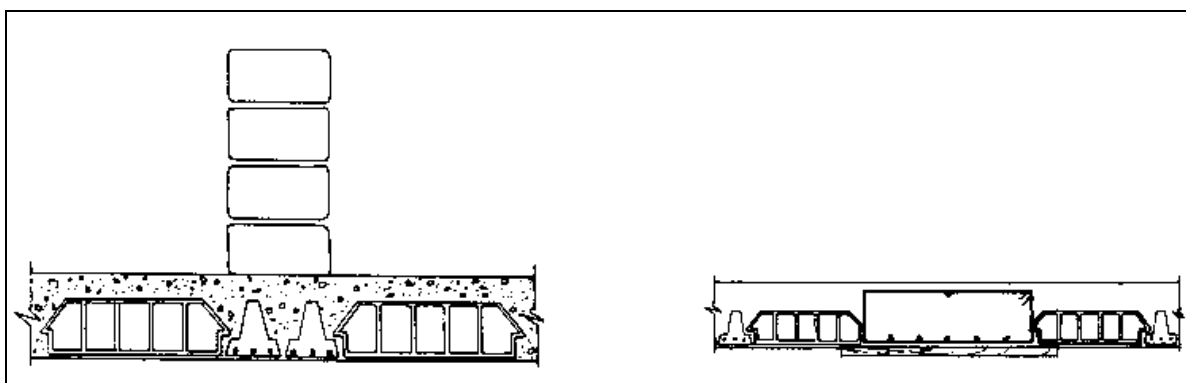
Parede sobre a laje (SOUZA & CUNHA, 1994).
